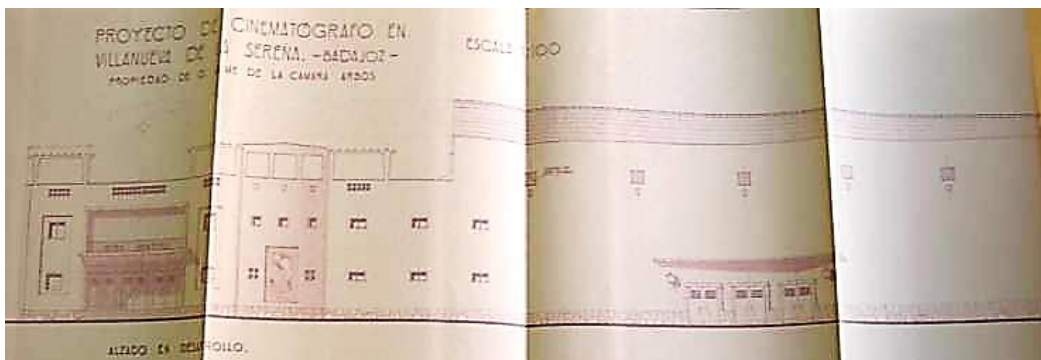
Plano del alzado en desarrollo (ROSADO, M., 1956).
